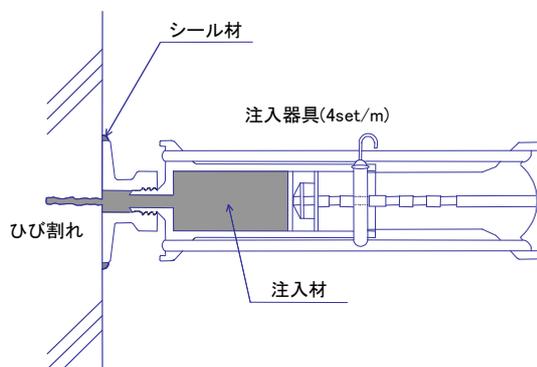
ひび割れ注入概念図と床版下面での注入工法
